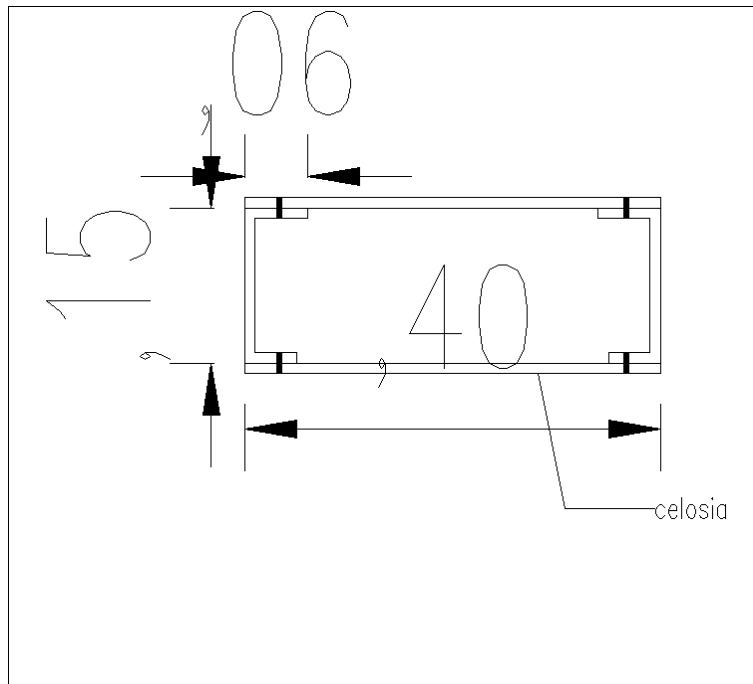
Sección del elemento tipo 2-25, Puente 2. Fuente (Autores).
